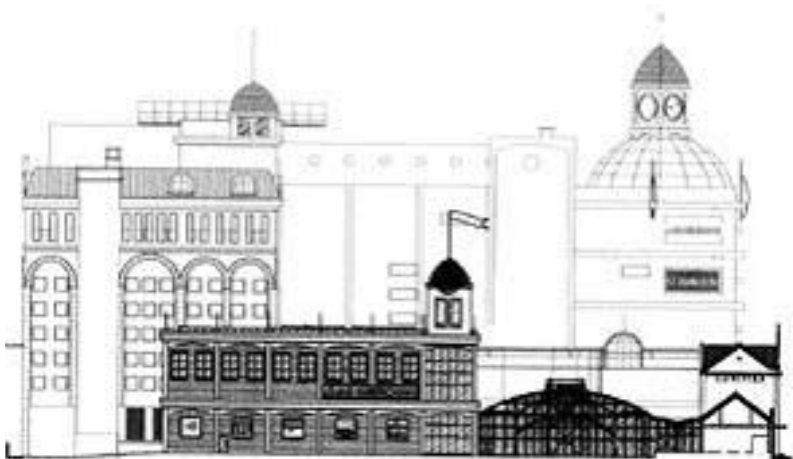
Elevação Oeste do Shopping Estação Curitiba
